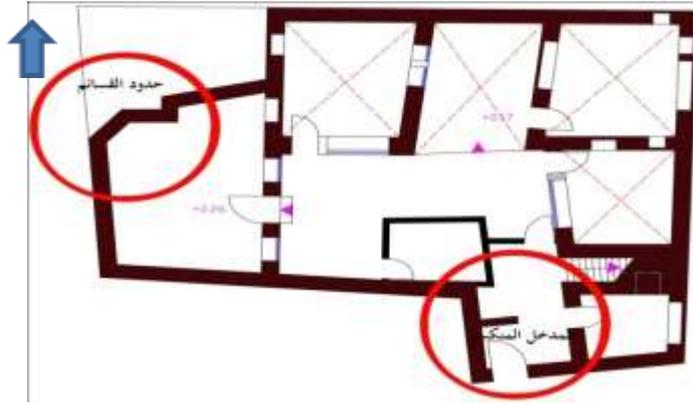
مسقط الدور الأرضي لبيت رشدي الشوا، حي الدرج
